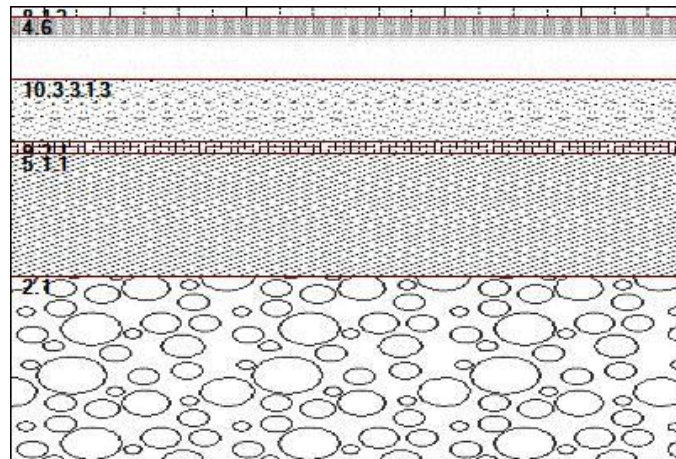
Gazbeton tuğla dış duvar kesit detayı
